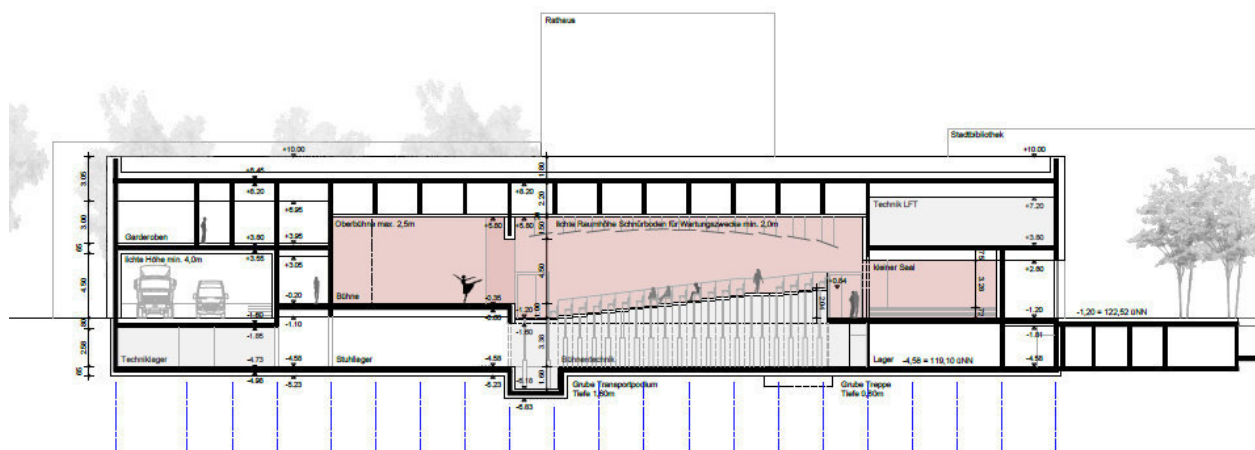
Längsschnitt Stadthalle gemäß [3.6]
